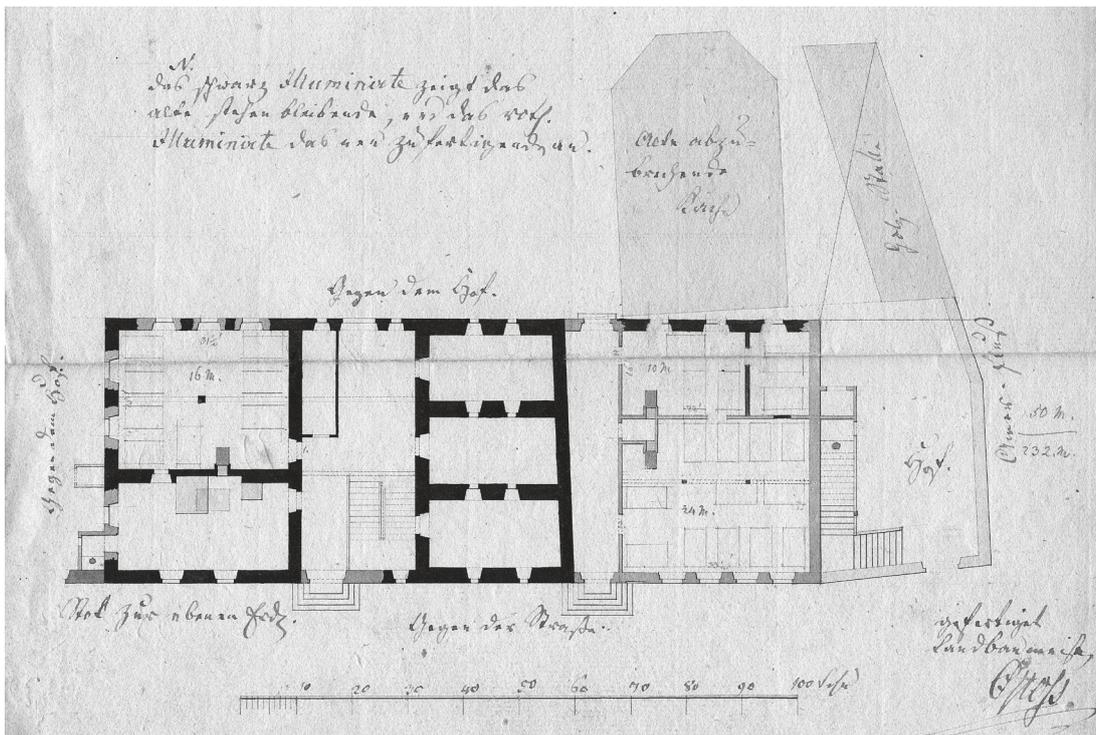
Tübingen, Spital. Umbauplan von Johann Adam Groß, Grundriss des Erdgeschosses, 1807.
